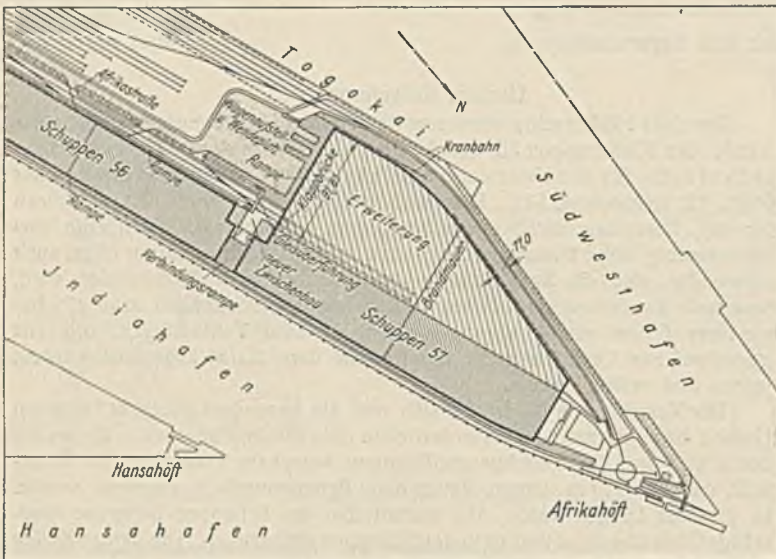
Grundriß der Erweiterung des Kaischuppens 57.
